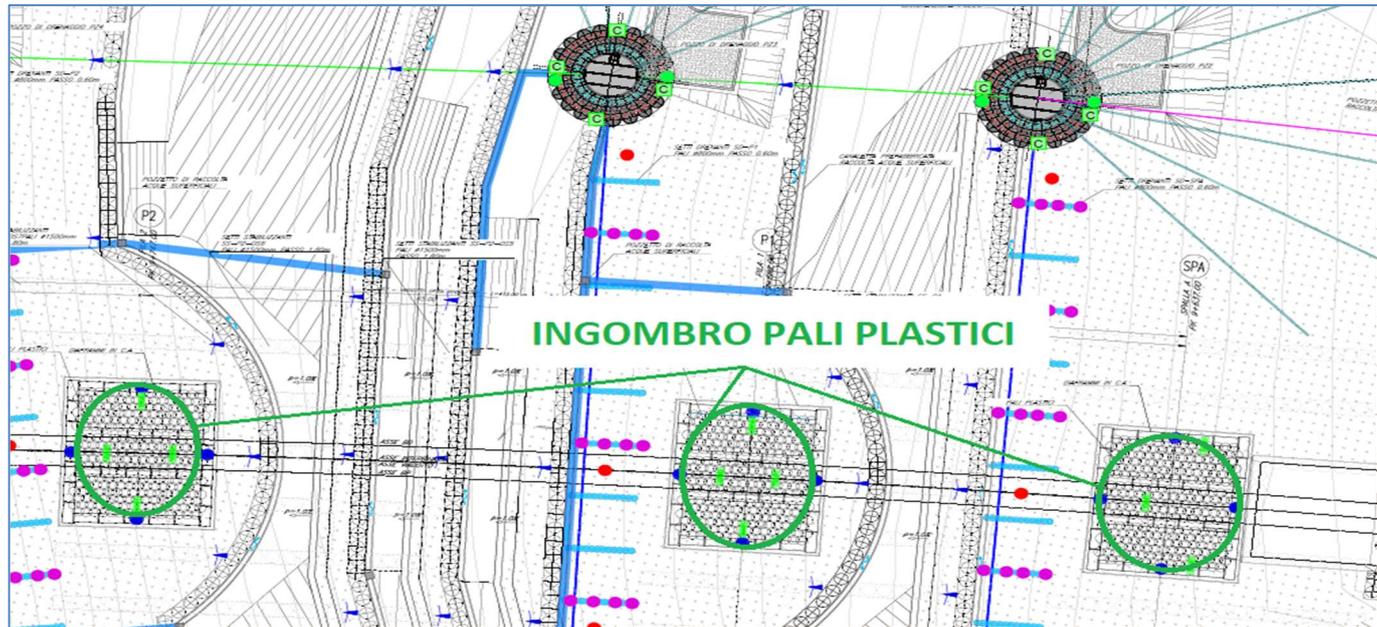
Stralcio Planimetrico con indicazione dei Pali Plastici
